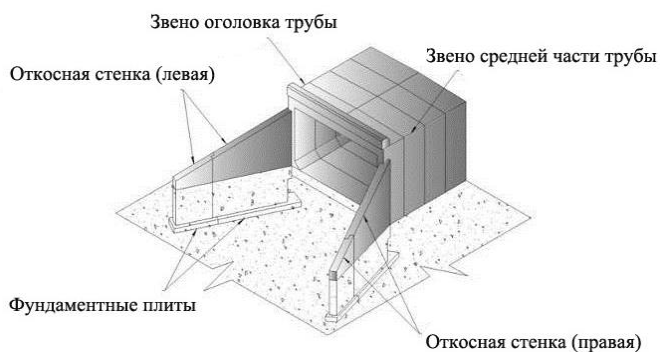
Конструкция прямоугольной водопропускной трубы
